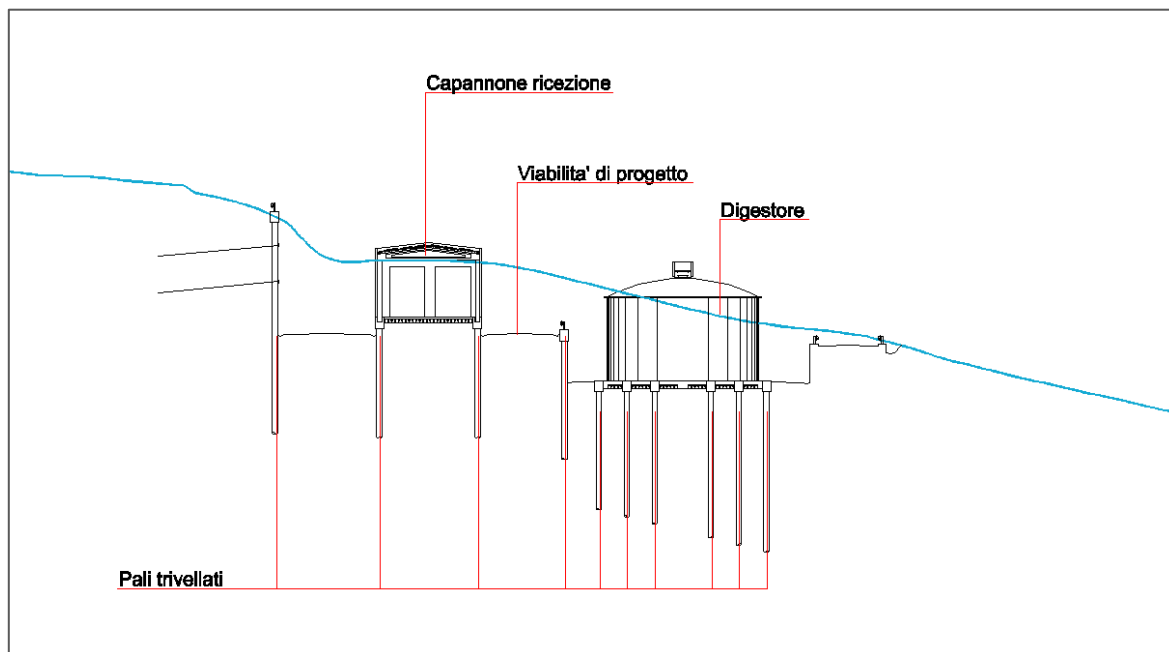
Confronto sezione J-J di progetto e ipotesi abbassamento quota 10 metri.
